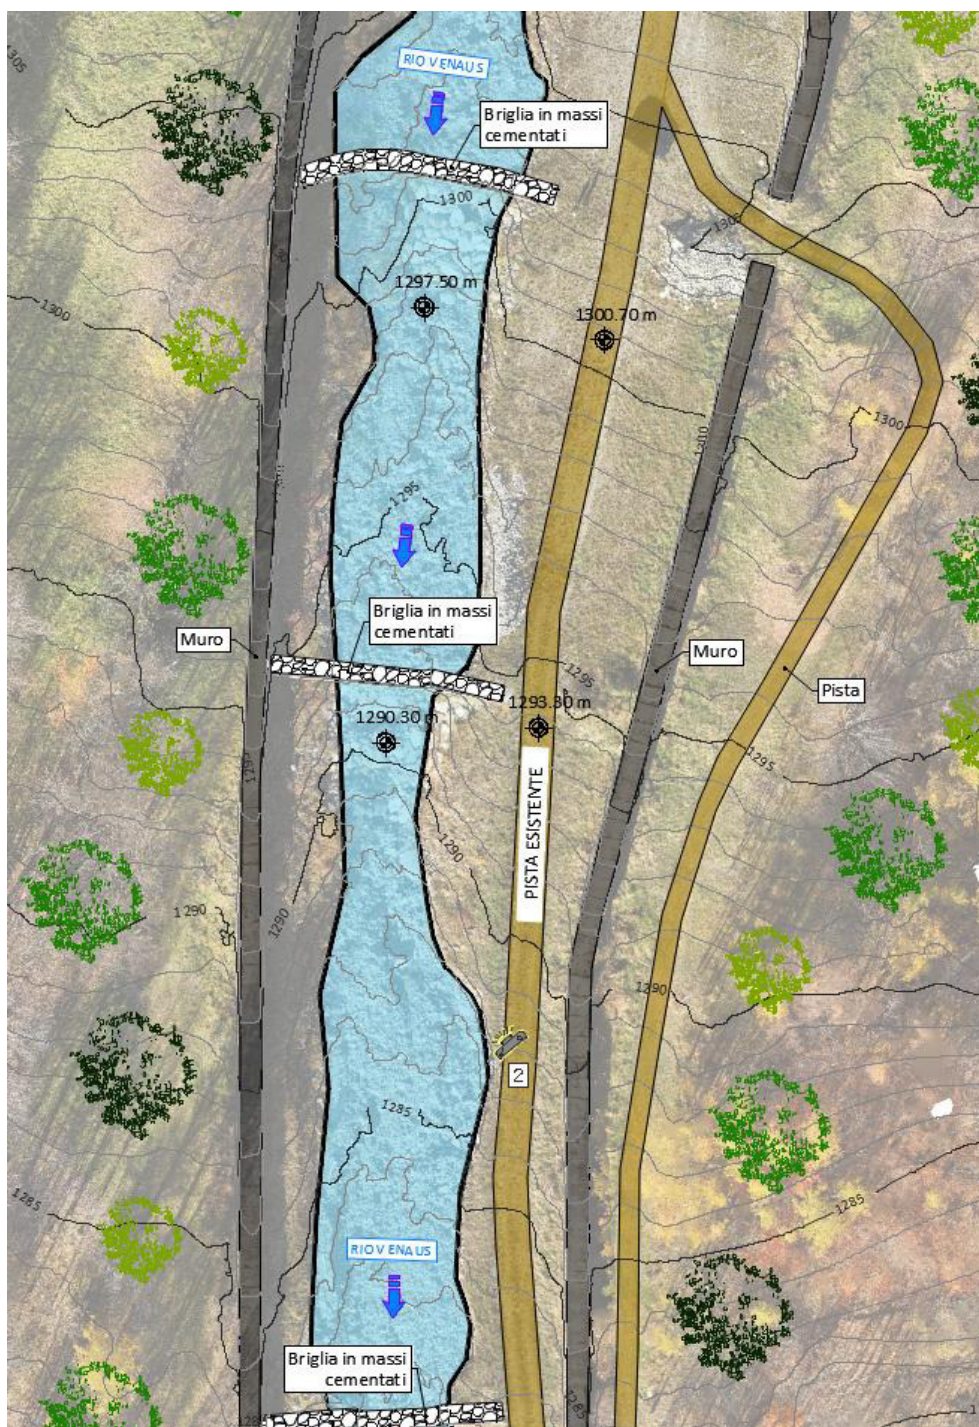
Estratto della tavola 04 - Planimetria di rilievo
